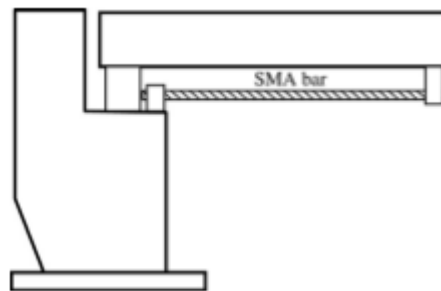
Schéma d'installation d'une barre en AMF sur un pont pour la prévention sismique. (Waibaye, 2016)
